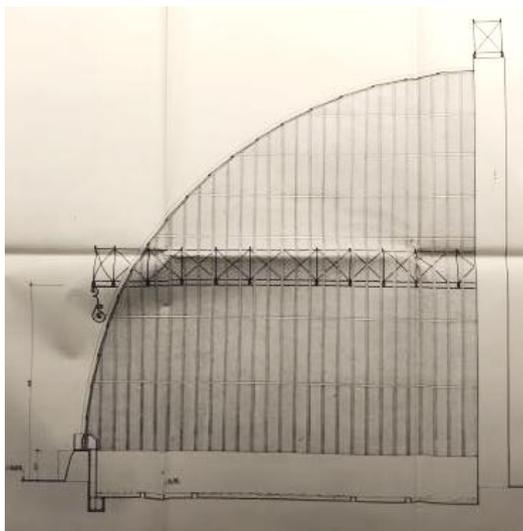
Proyecto de restauración de la Estufa Tropical, Sección.* (1988) Carlos Bento.
